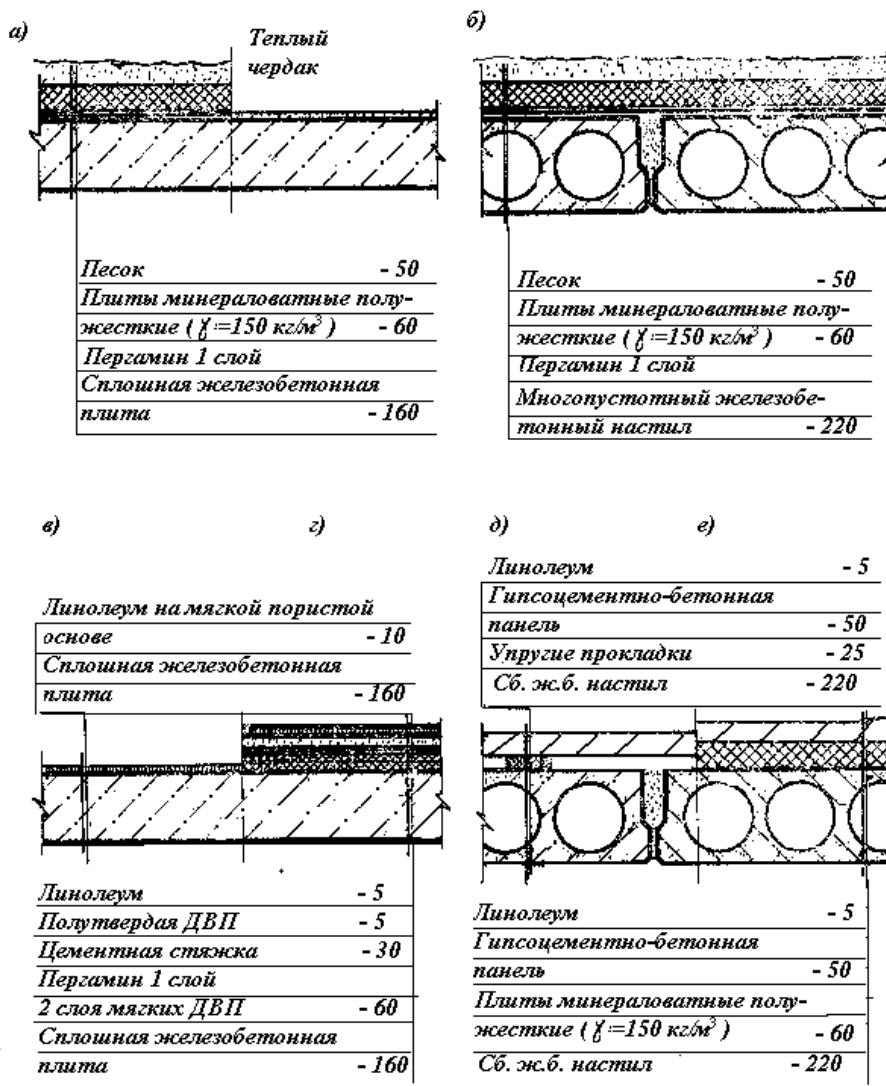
Конструкции перекрытий; а, в, г – из сплошных плит, б, д, е – из уширенных пустотных настилов, а, б – чердачные, в, д – междуэтажные, г, е – надподвальные
